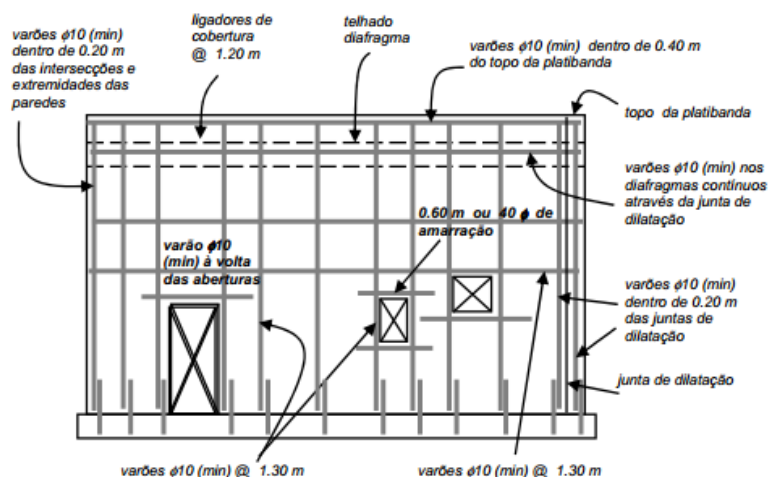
Solução típica americana de uma parede com aberturas de alvenaria armada. [12]
